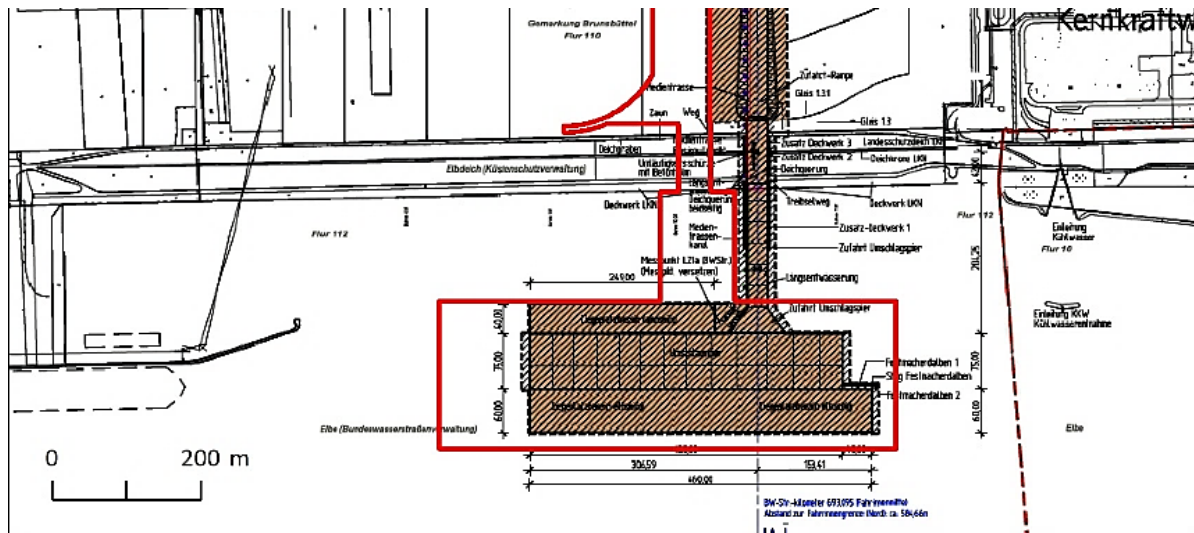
Überlagerung des planfestgestellten Vielzweckhafens mit dem geplanten Geltungsbereich des LNG-Terminals im wasserseitigen Bereich
